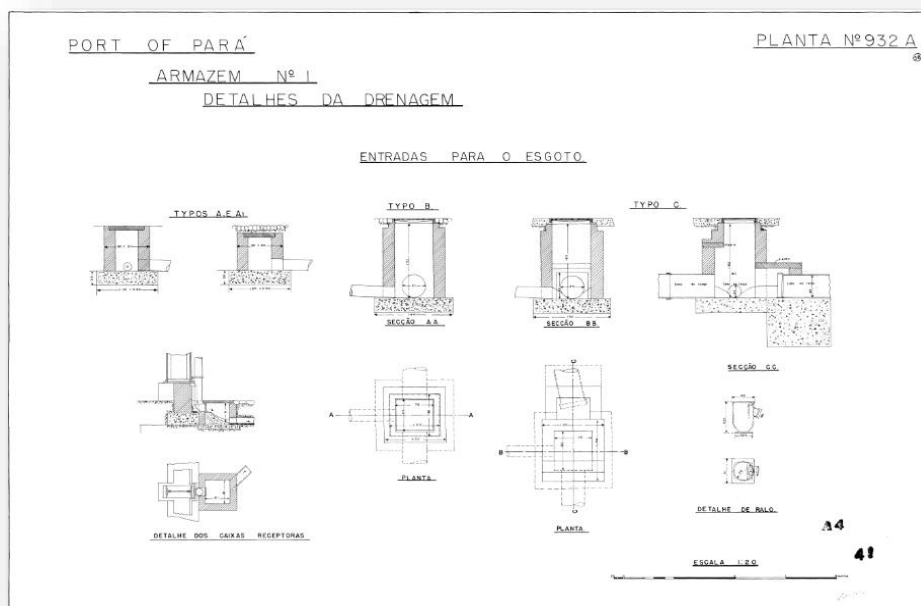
Planta geral de drenagem das Aguas pluviais e Esgoto
